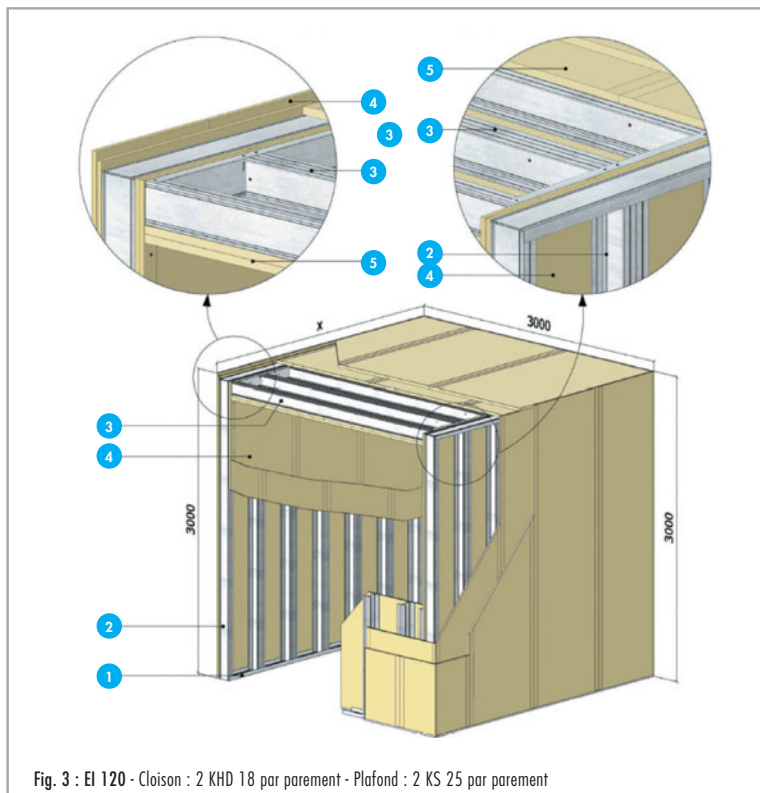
El 120 - Cloison : 2 KHD 18 par parement - Plafond : 2 KS 25 par parement
